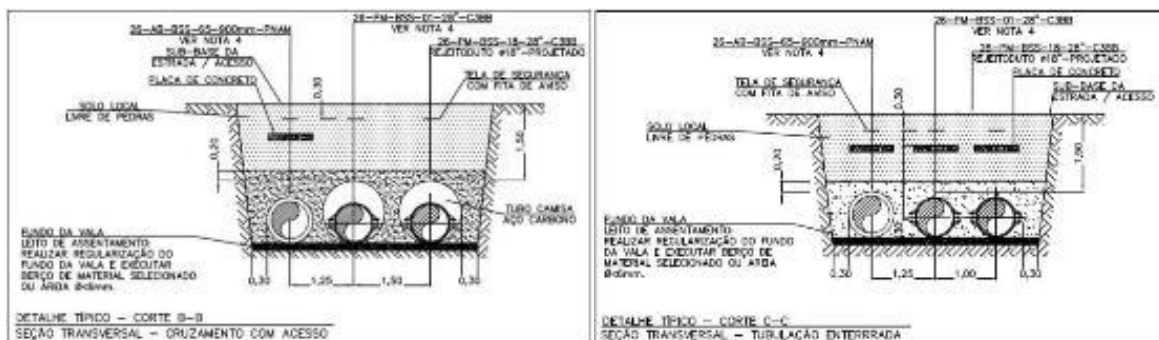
Detalhes típicos trechos tubulação enterrada
